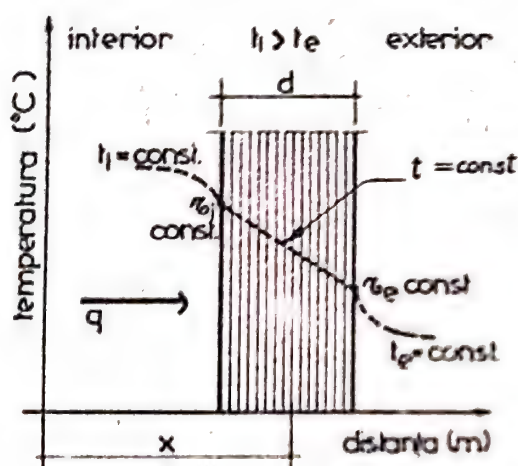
Câmpul termic constant în planele paralele cu peretele.
